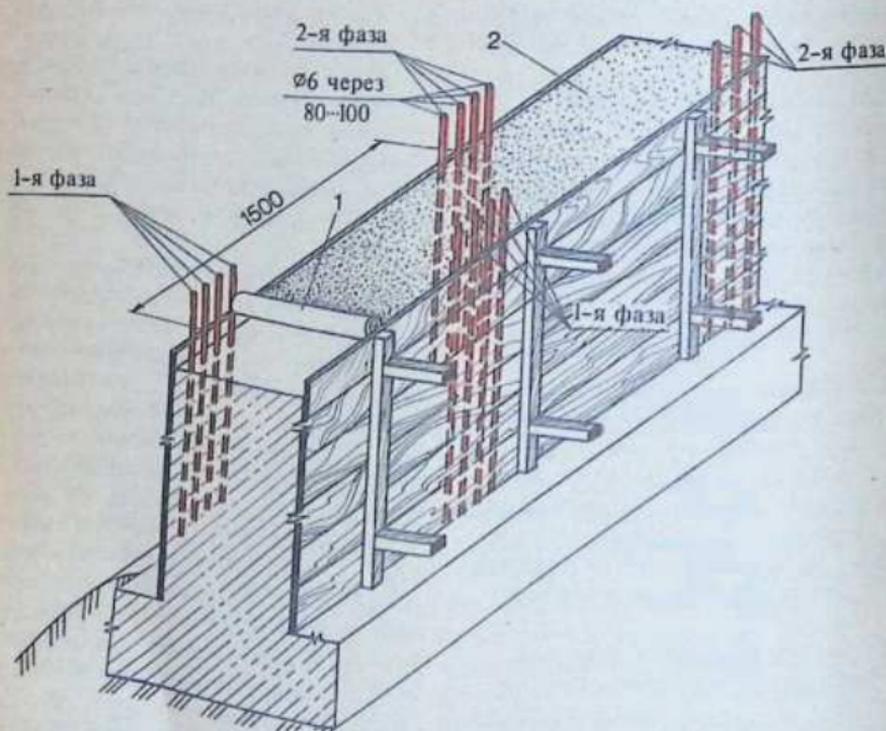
Электропрогрев бутобетонного фундамента (сетевое напряжение 120 ... 220 В) при групповом расположении нашивных электродов:
